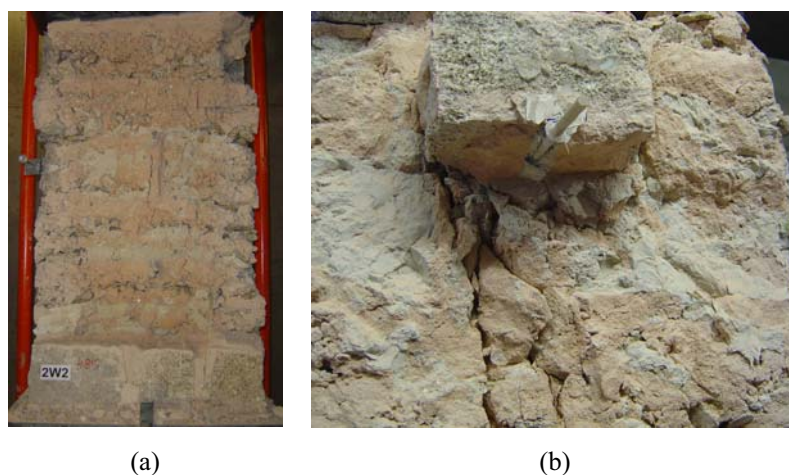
Aspecto do pano interno das paredes reforçadas com pregagens transversais: (a) pano interno da parede 2W2; (b) pormenor de uma pregagem da parede 2W4.
